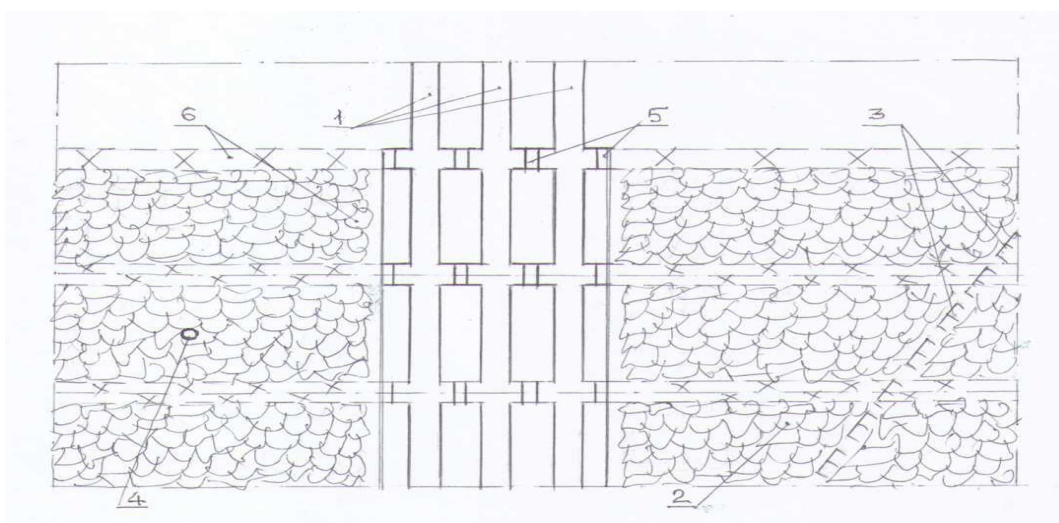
Схема расположения угрожаемых зон: 1 – наклонные выработки; 2 – отработанное пространство; 3 – тектоническое нарушение; 4 – скважина; 5 – перемычки; 6 – угрожаемые зоны
